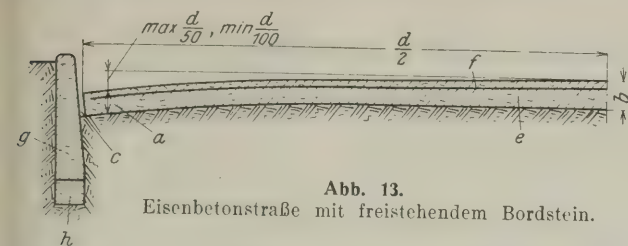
Eisenbetonstraße mit freistehendem Bordstein.
